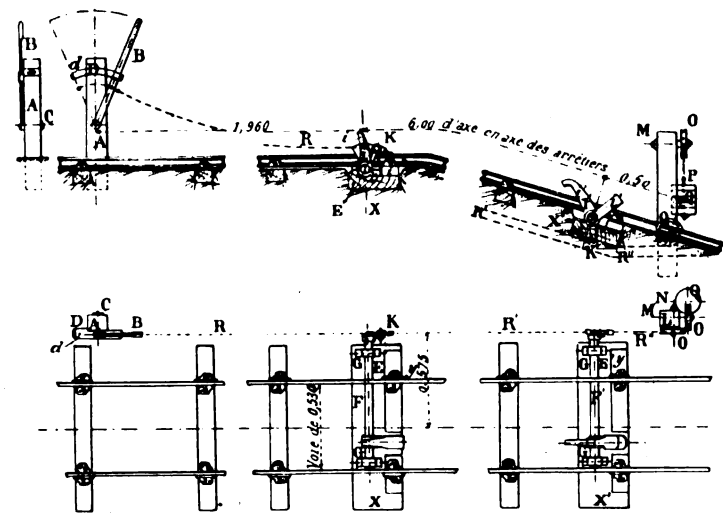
et 2. — Arrêtier double d'équerre pour plan incliné : Ensemble en élévation et en plan.
